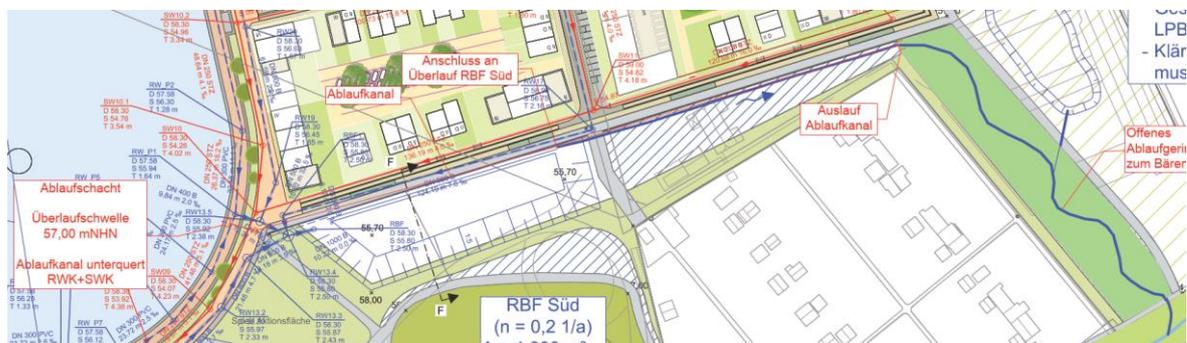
Ableitung zum Bärenbach entlang RBF Süd+Straße (Kastenprofil) und offenen Graben (blau)
